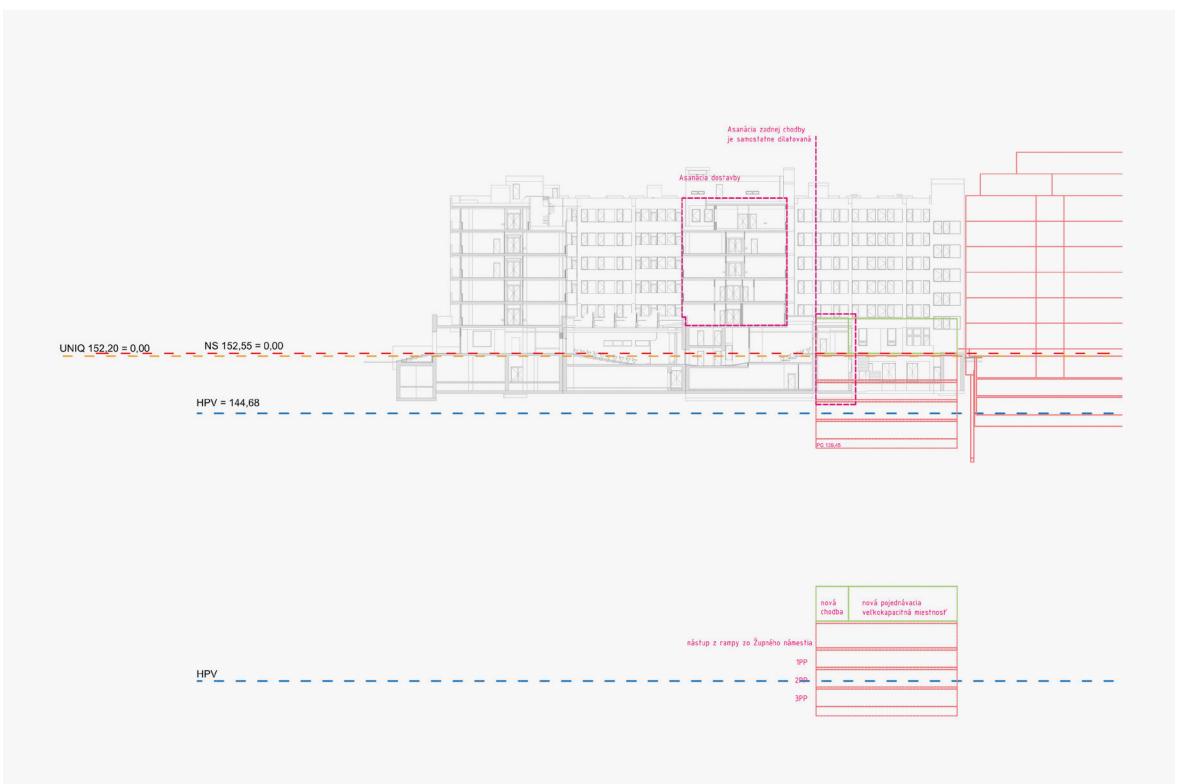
Uvažovaná pozícia podzemného parkovacieho domu vo dvore budovy NS SR; Zdroj: Metropolitný inštitút Bratislavky, 2023
